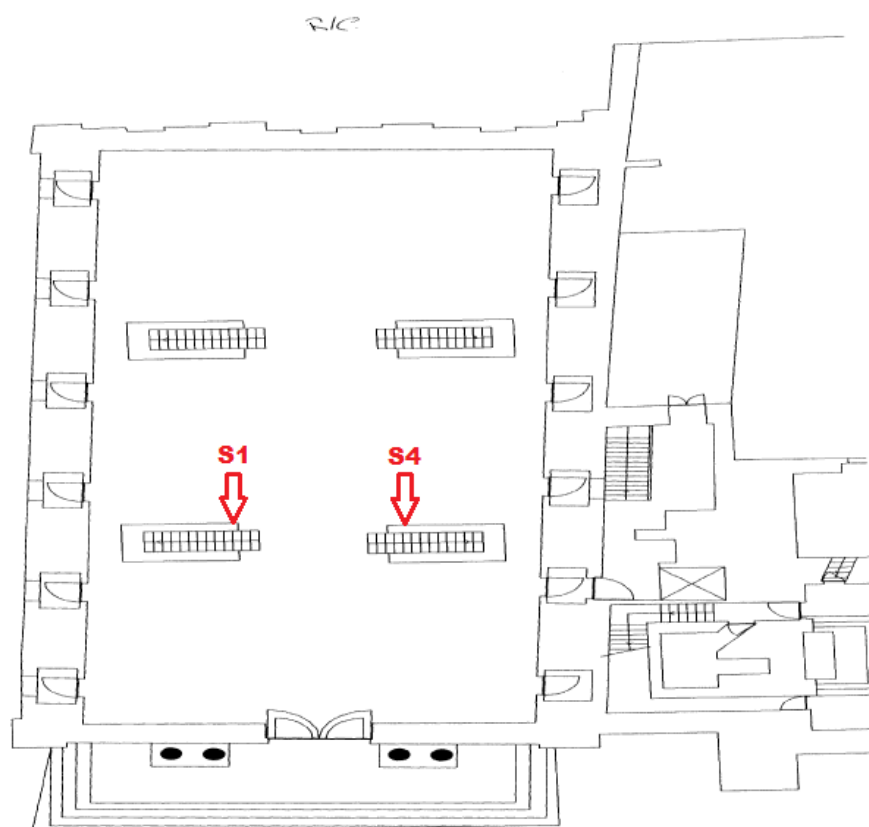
Planta do piso nobre da Biblioteca Joanina e localização dos sensores
